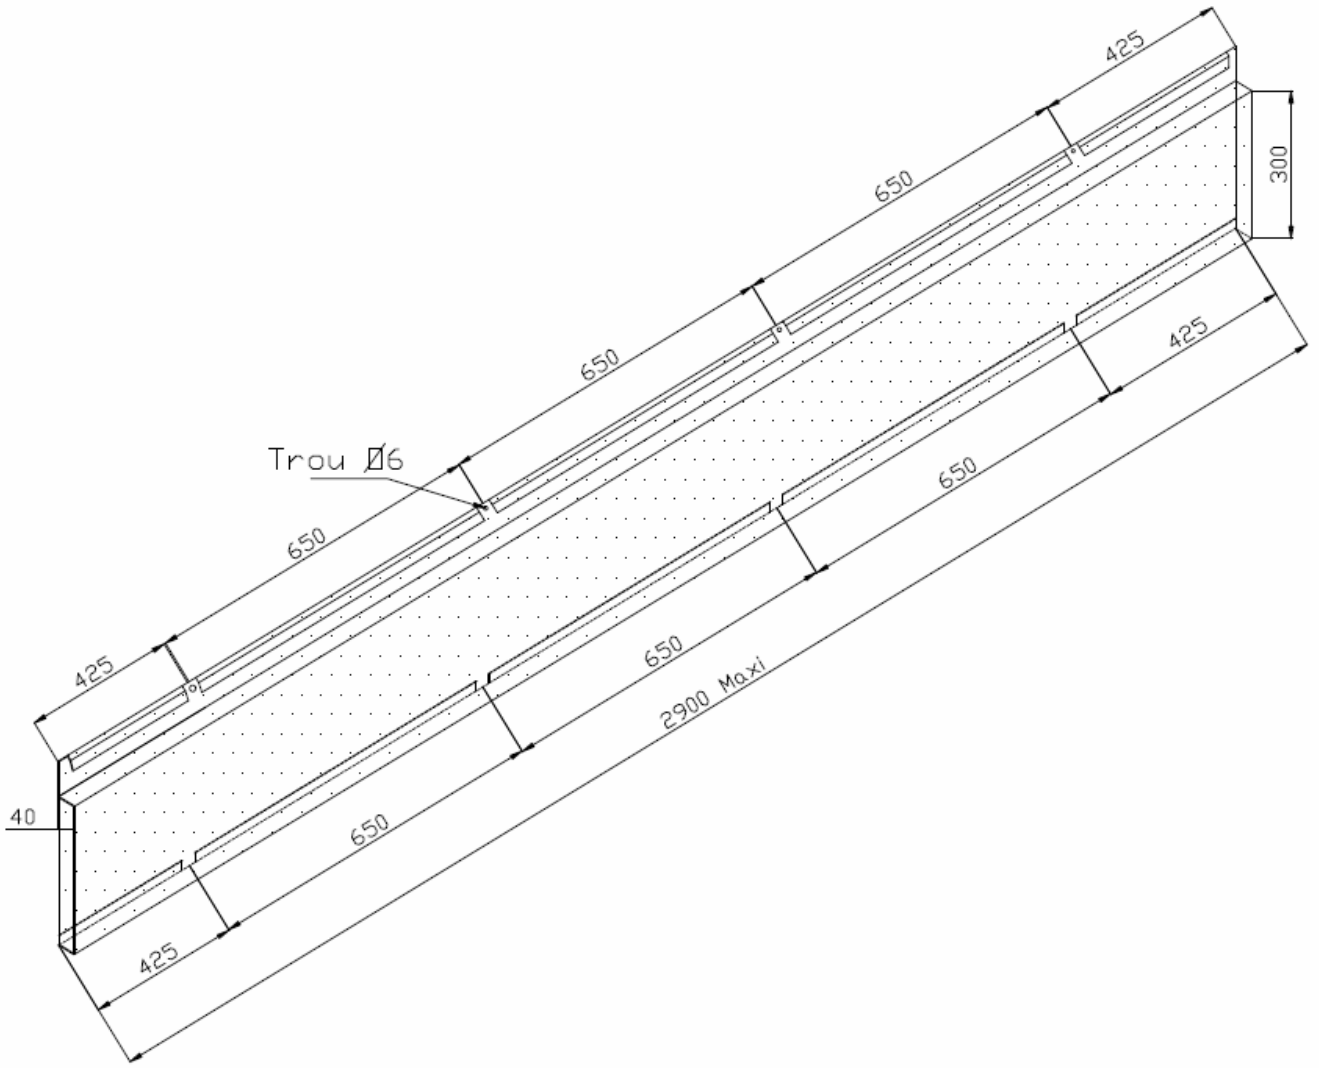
Cassettes STONE ALU de hauteur 300 mm
